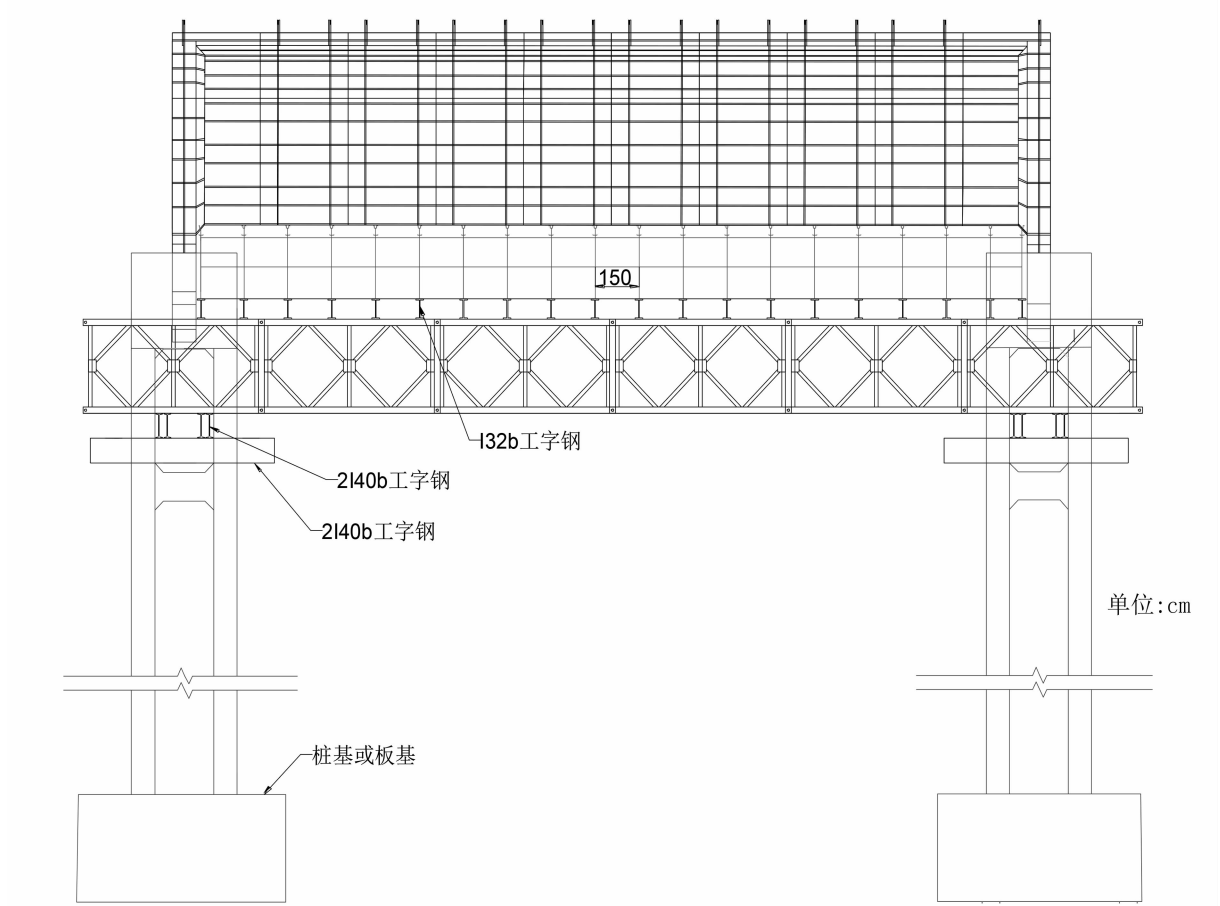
永久结构横梁+贝雷架施工支架纵剖面示意图
